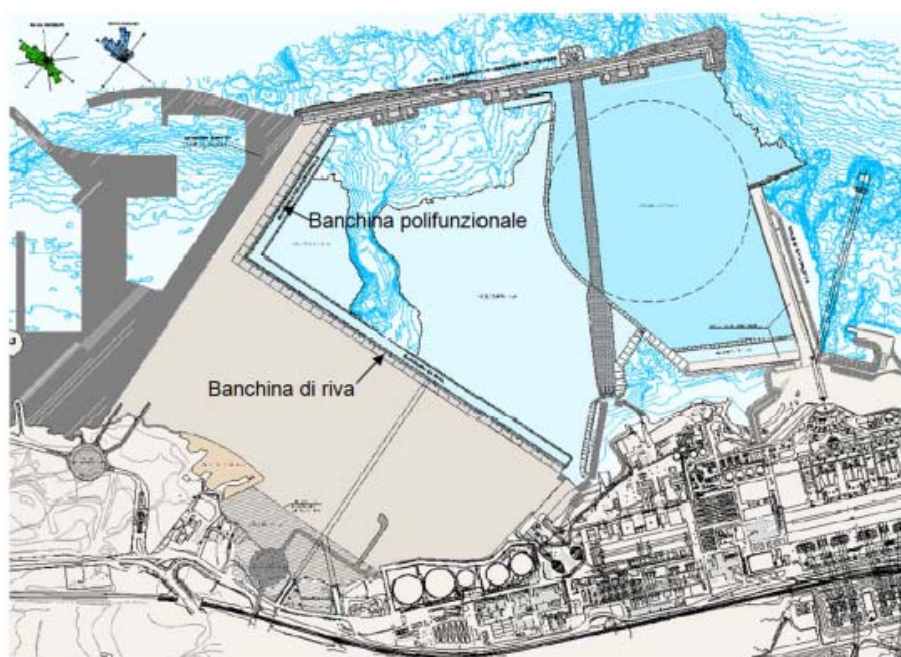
Planimetrie di progetto PRP 2004:D.E.G.M..
